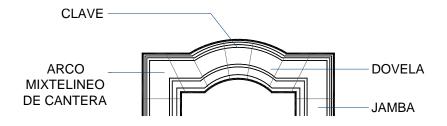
Detalle del cerramiento de las ventanas la fachada.
